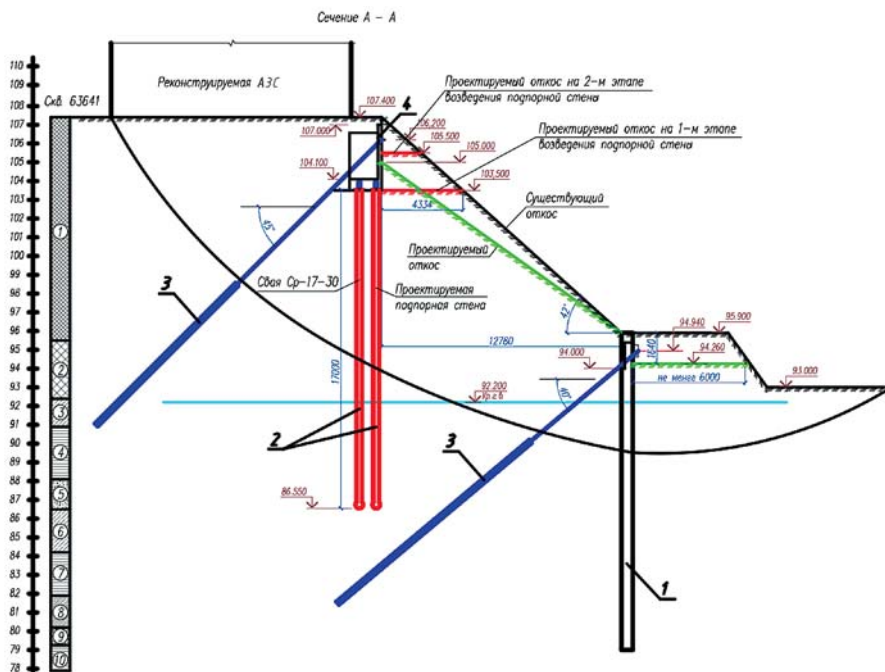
Поперечное сечение прислоненного откоса с противооползевыми заглубленными железобетонными конструкциями: 1 – существующая подпорная стена из буронабивных свай диаметром 500 мм; 2 – буронабъекционные сваи ЭРТ усиления основания в два ряда; 3 – грунтовые анкера ЭРТ усиления склона; 4 – монолитная угловая железобетонная подпорная стена
